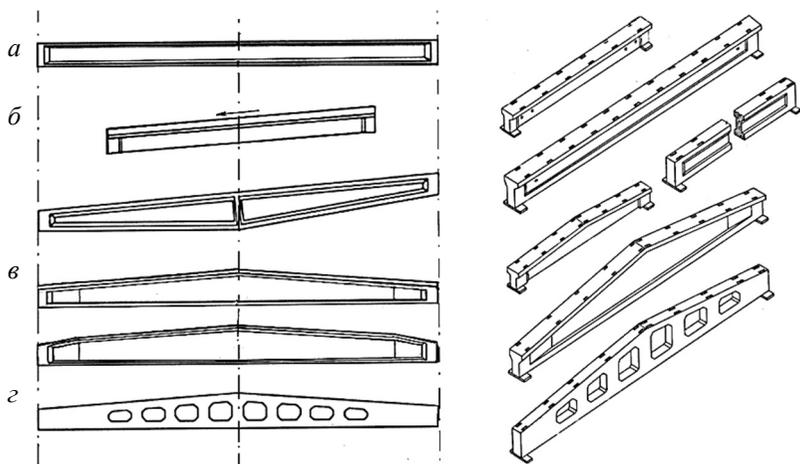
Железобетонные стропильные балки покрытий:
